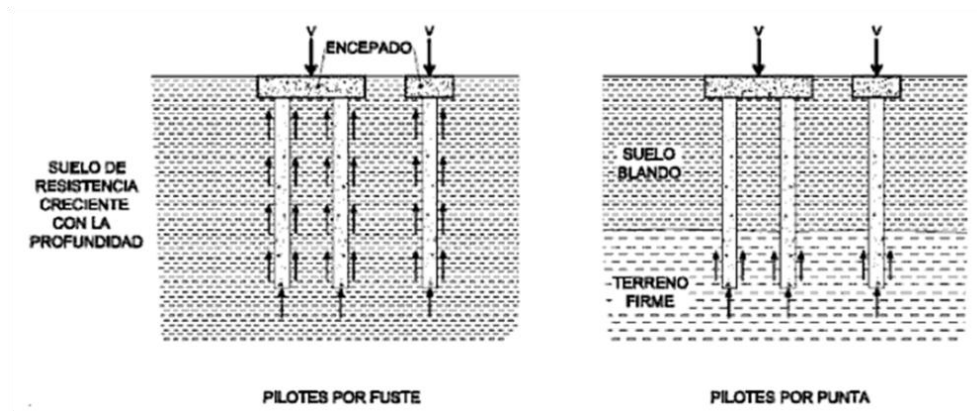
Pilotes que trabajan por fuste y por punta
